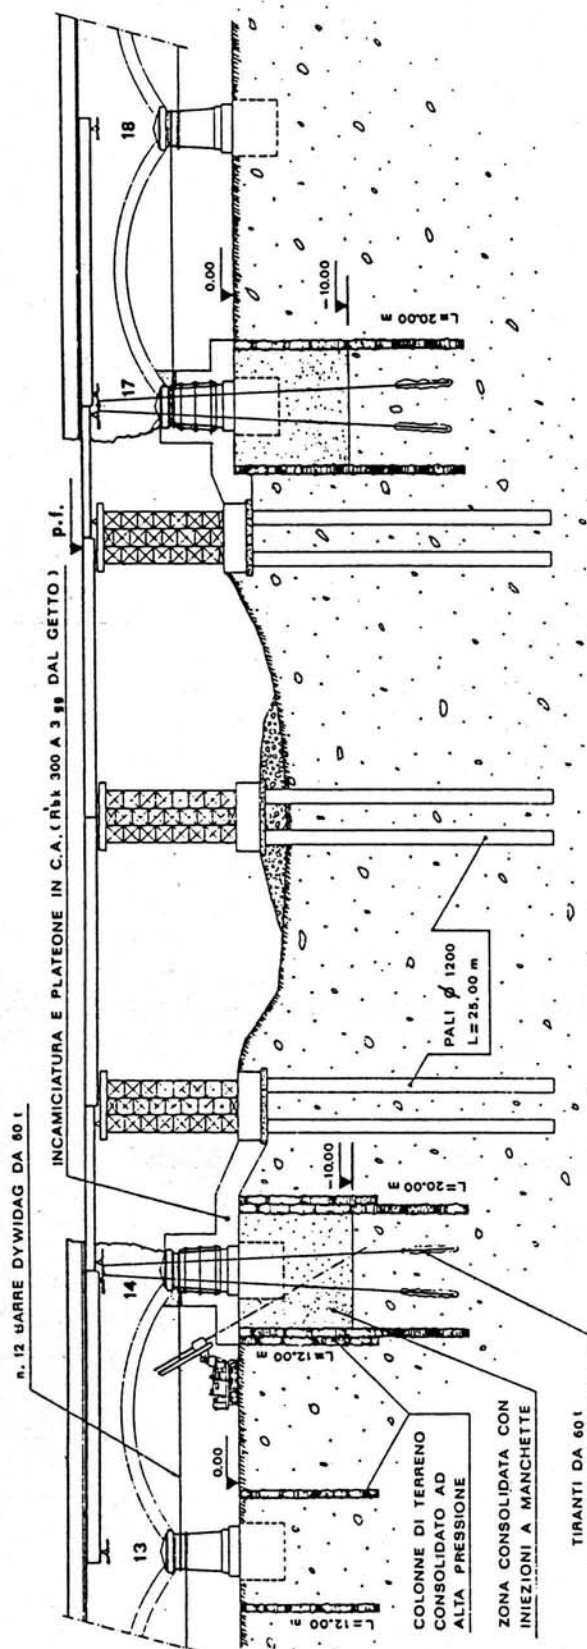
Fondazione delle stilate provvisorie : consolidamento e recupero delle strutture danneggiate
